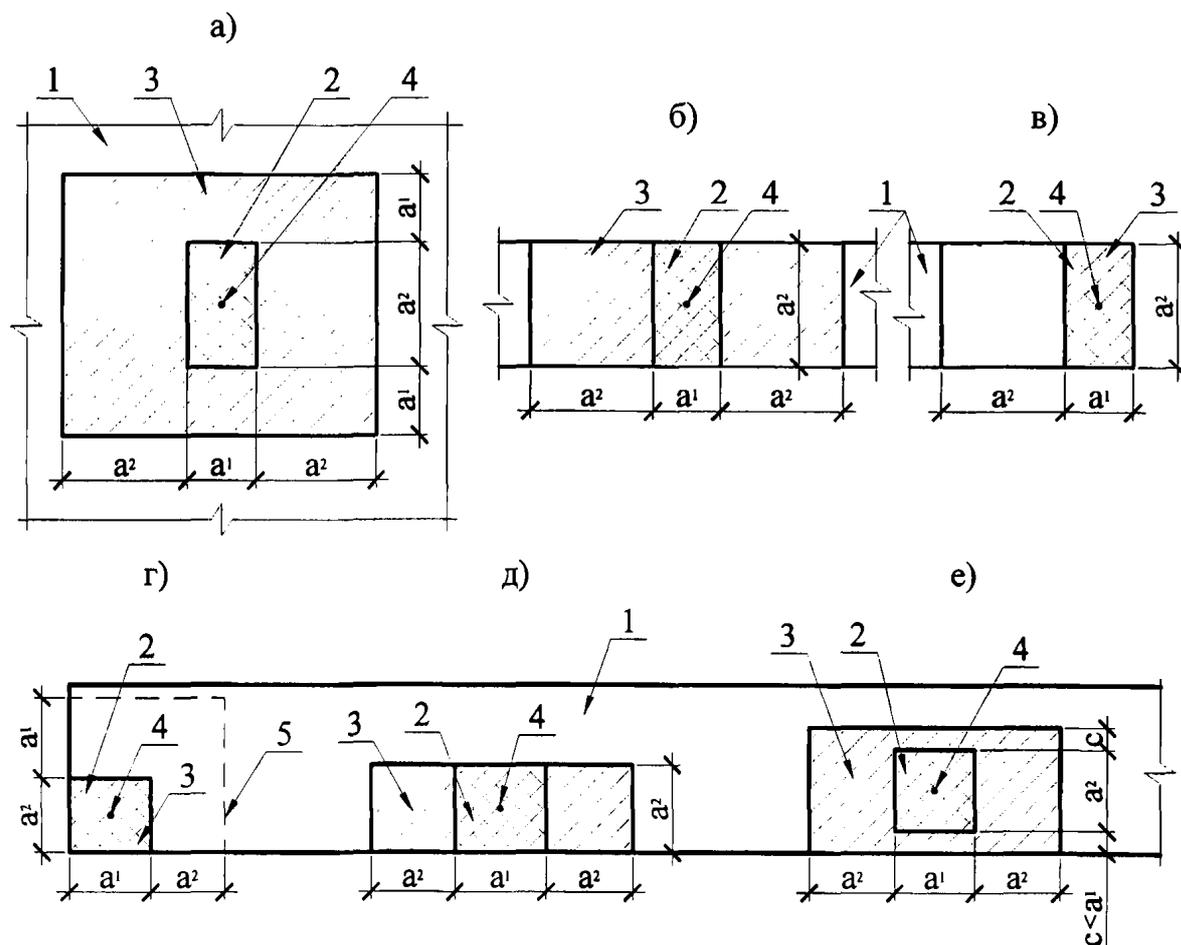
Схемы для расчета элементов на местное сжатие при расположении местной нагрузки:
